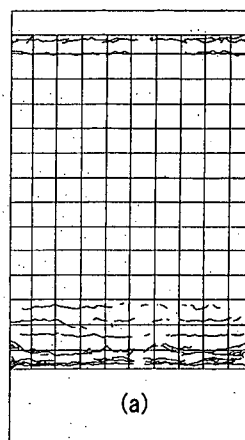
非岩着試験体のひび割れ状況（東側壁）
